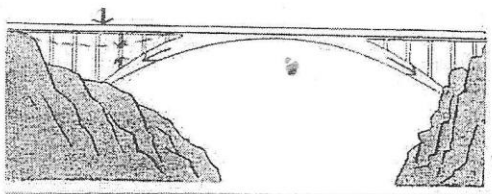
a: La calzada vehicular se apoya mediante pilares sobre el enorme arco de hormigón.
